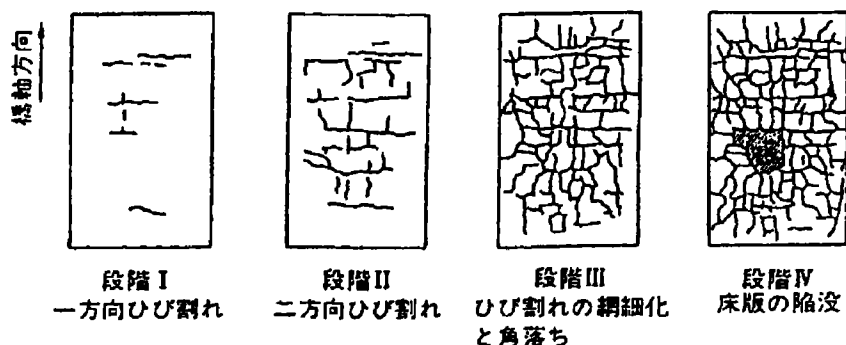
道路橋 RC 床版のひび割れ損傷過程
